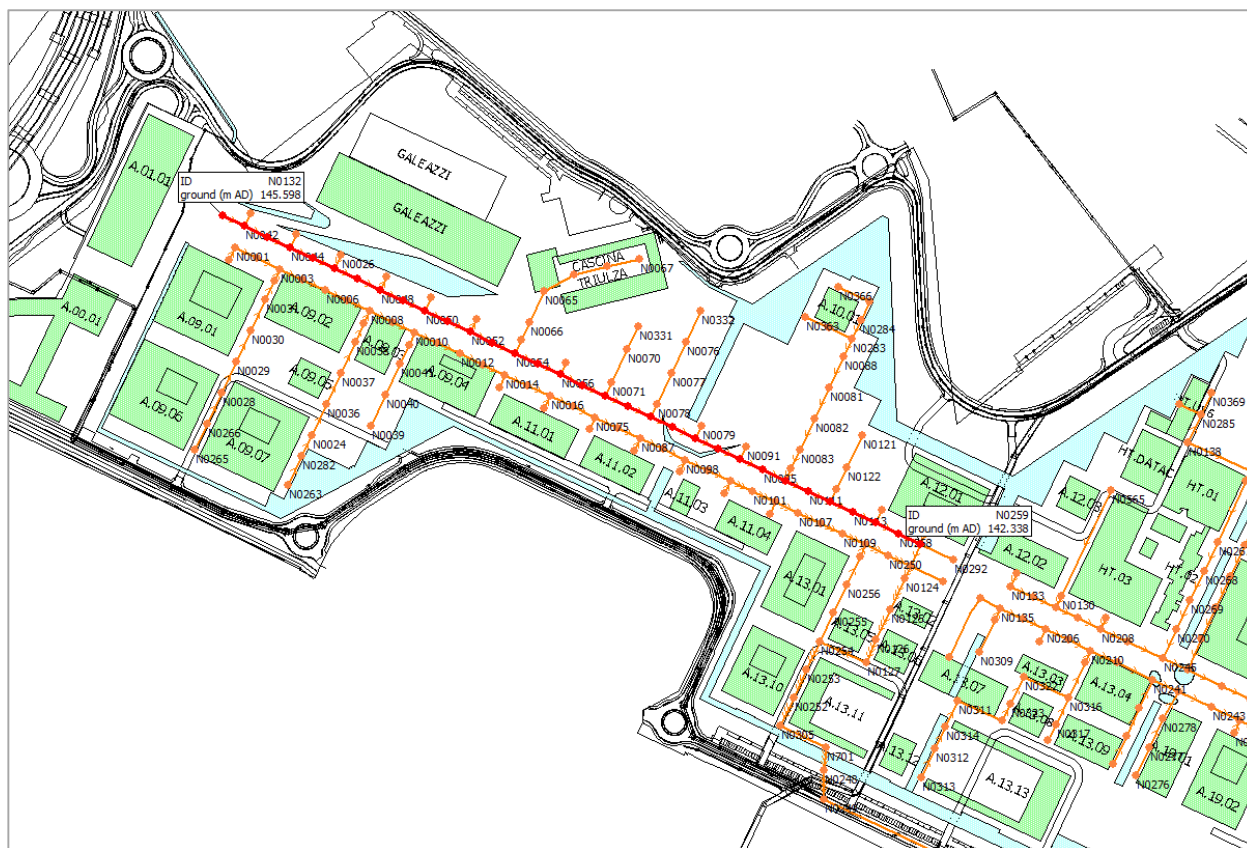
Stralcio planimetrico del tratto di profilo sopra riportato (in rosso i condotti selezionati)
